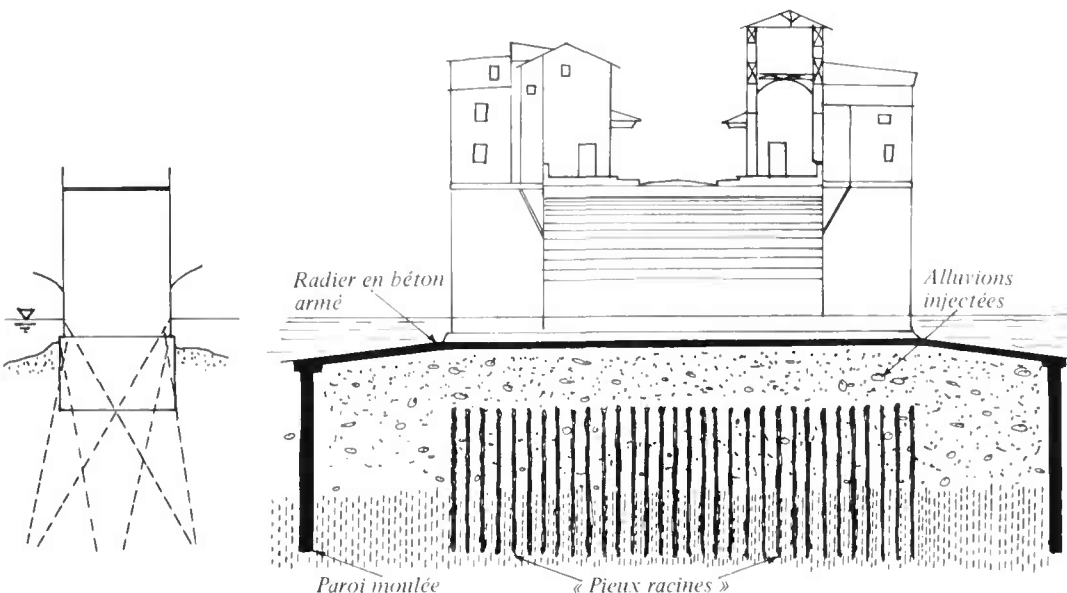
Ponte Vecchio - Schéma d'ensemble du confortement.
